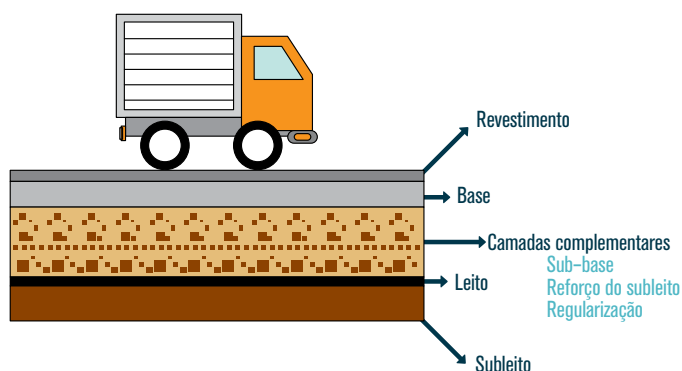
Disposição das camadas que compõem pavimentos flexíveis (CNT, 2016).
